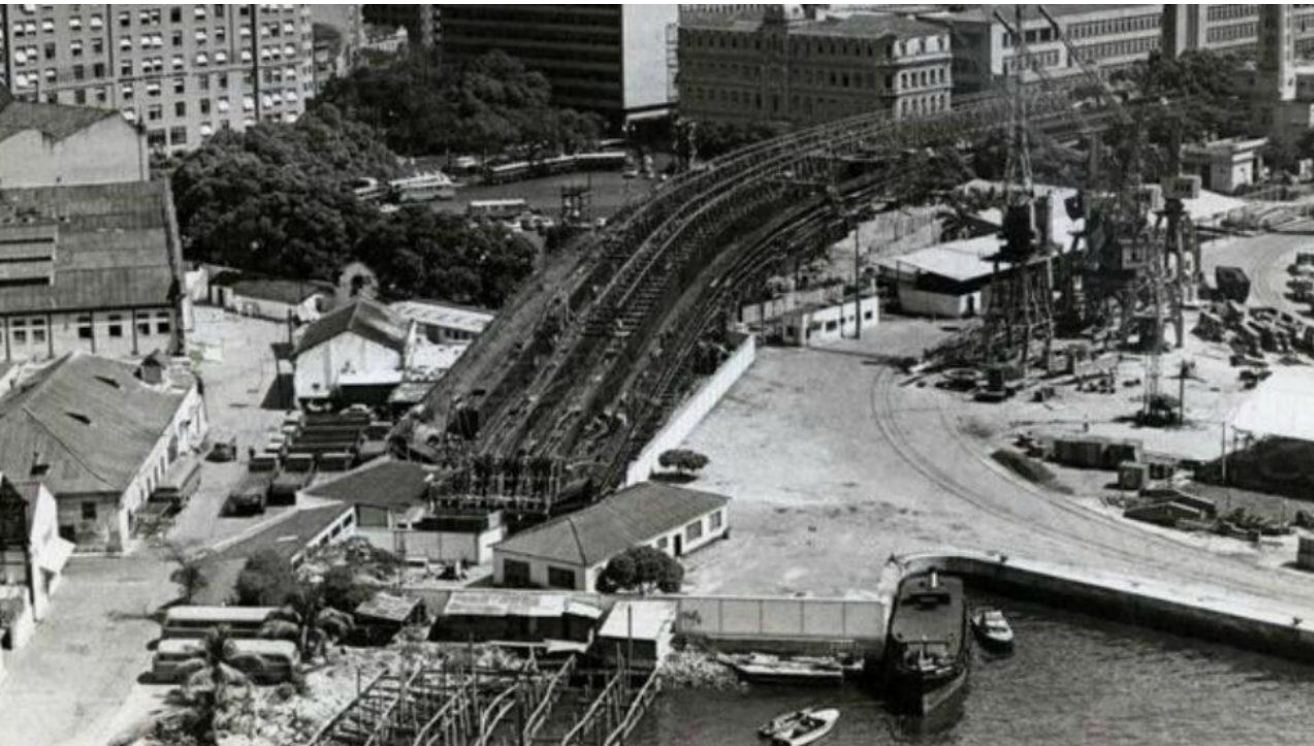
Construção da Perimetral. Imagem: Diário do Rio.
